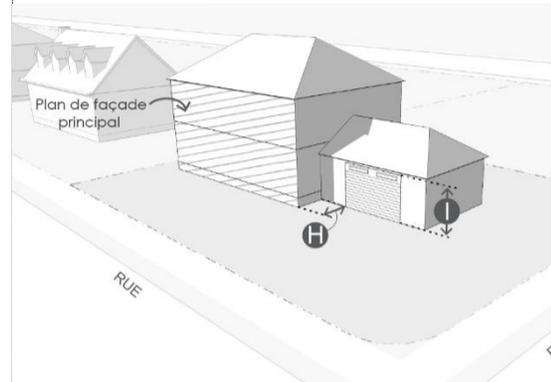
Retrait d'un garage par rapport à un plan de façade principal et hauteur d'une porte de garage
